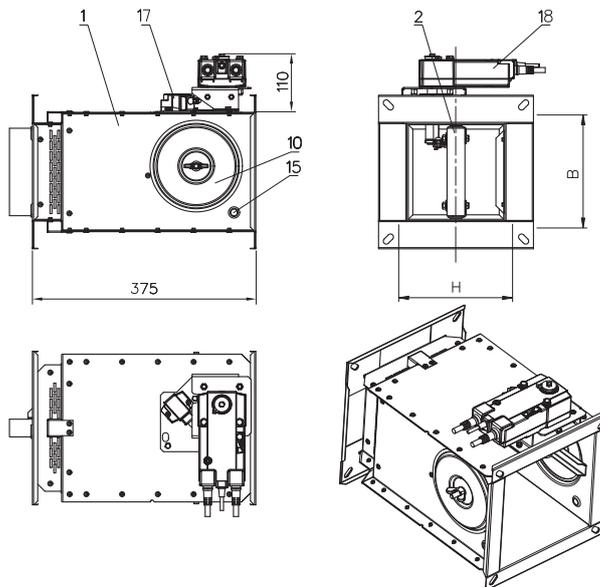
MECHANISCHE AUSFÜHRUNG mit Schmelzlot
